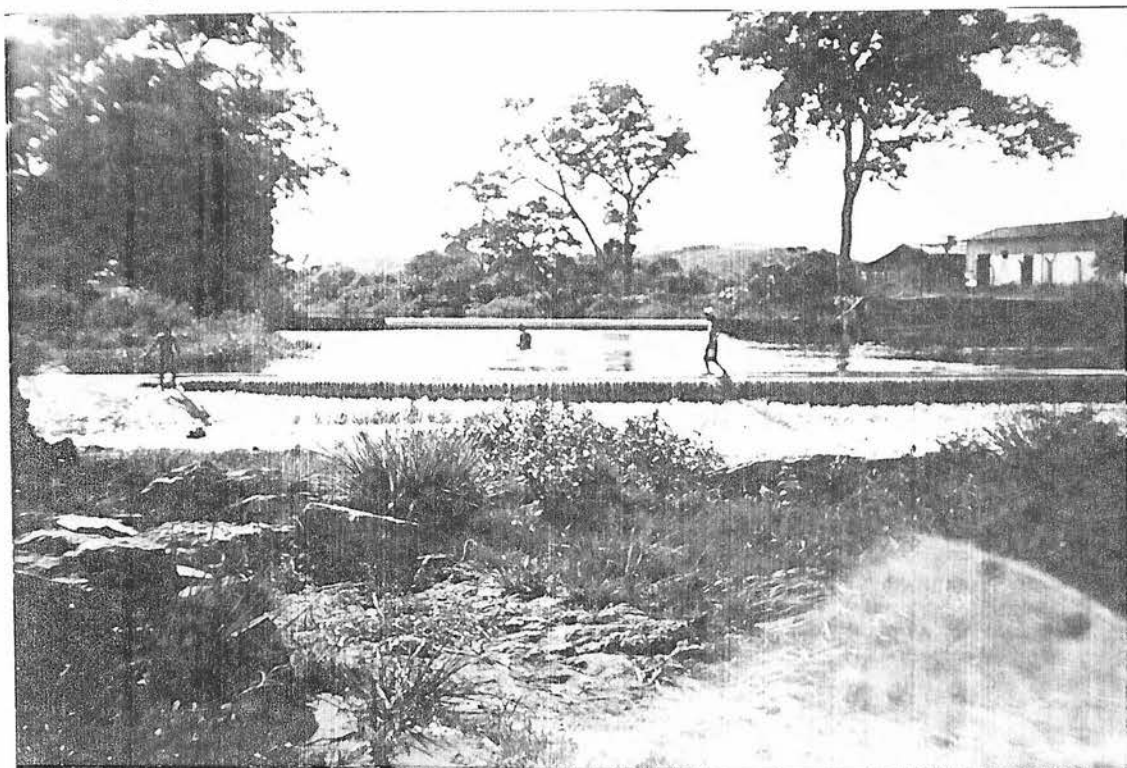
Captação COPASA em Porteirinha Vista de Jusante
